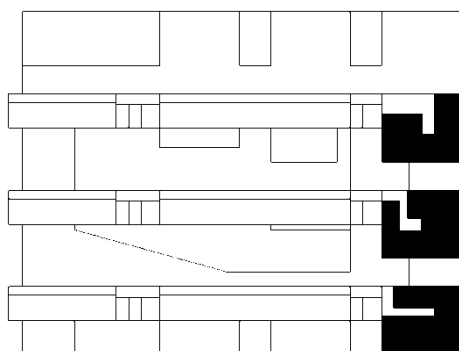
Plano de situación Despachos de Secretaría Plantas 1 y 2
